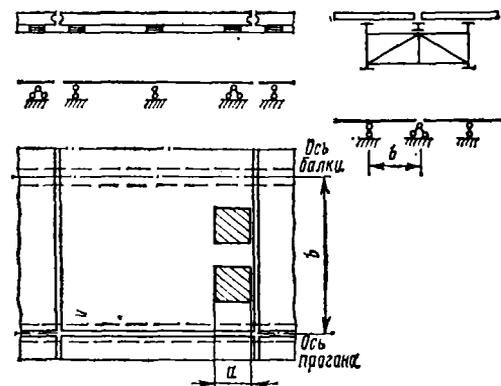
Схемы к проверке прочности железобетонных плит проезжей части
